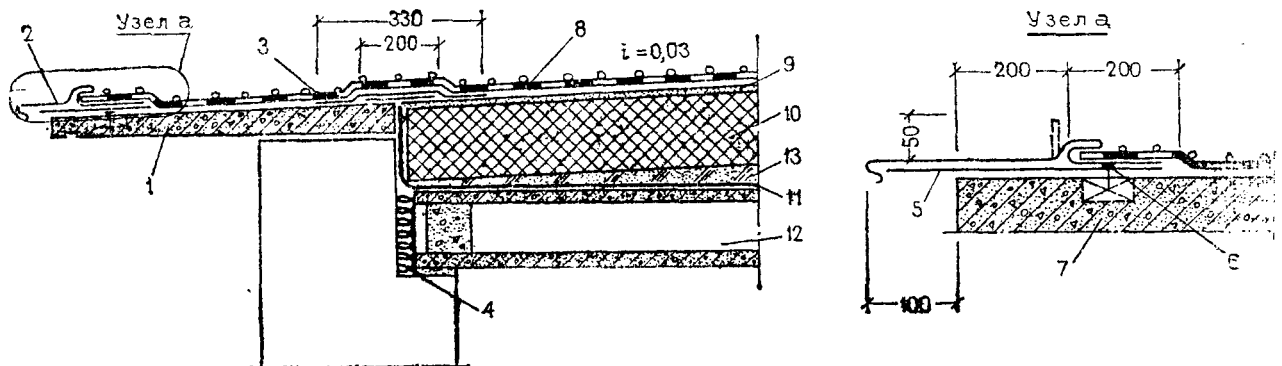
Конструкция неventилируемого бесчердачного совмещенного покрытия с наружным отводом воды
